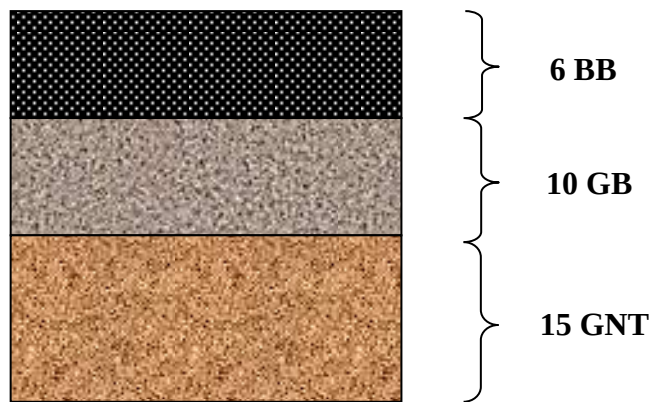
La structure de notre chaussée selon la méthode C.B.R.
